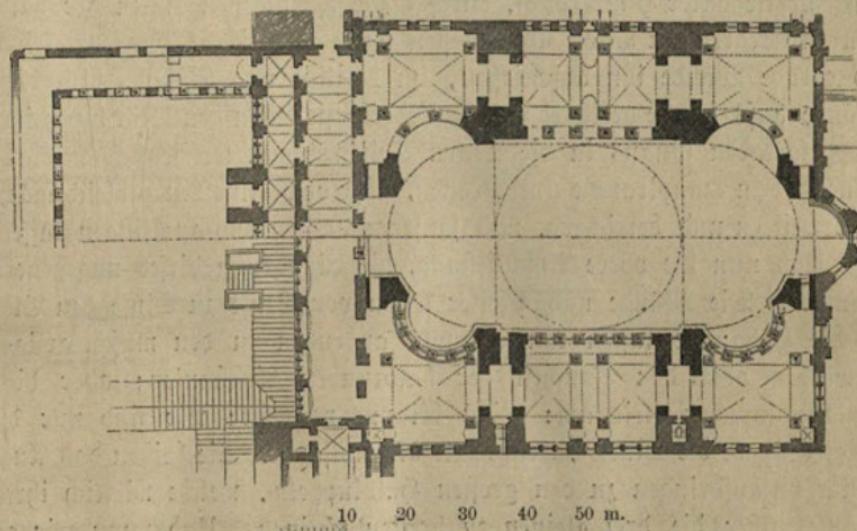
Grundriss der Aja Sophia in Stambul.
